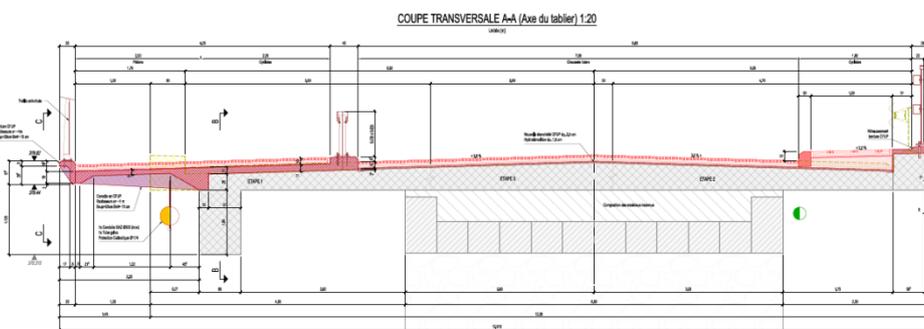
Elargissement du pont sur la Boiron (coupe transversale)
